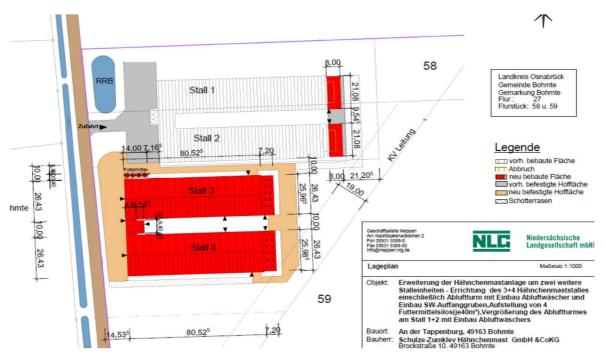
Lageplan der geplanten Hähnchenmastanlage mit Kennzeichnung der Betriebseinheiten (Quelle: NLG Osnabrück, Stand 08.02.2017)
